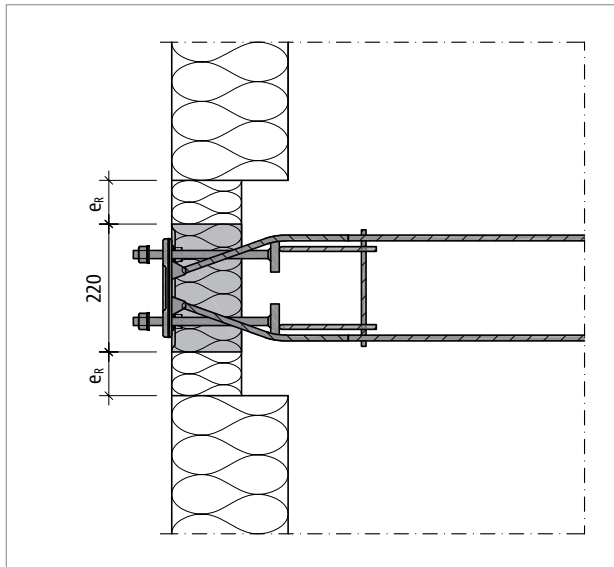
Schöck Isokorb® XT Typ SQP: Randabstände
